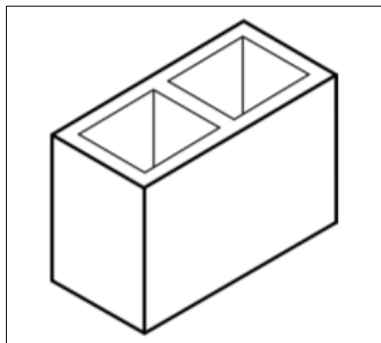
Bloco cerâmico estrutural de paredes vazadas
